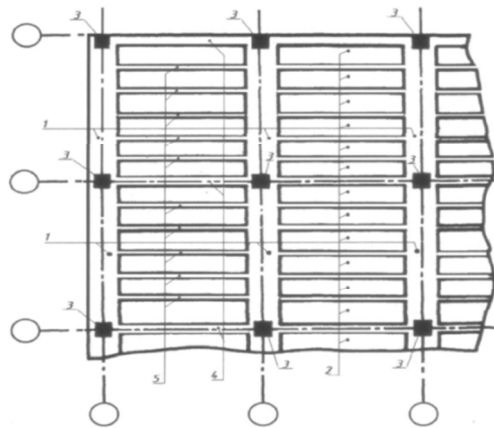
Фрагмент перекриття системи «Сочі»: 1 – монолітні ригелі; 2 – збірні плити перекриття; 3 – колони; 4, 5 – монолітні балки між колонами та збірними плитами
